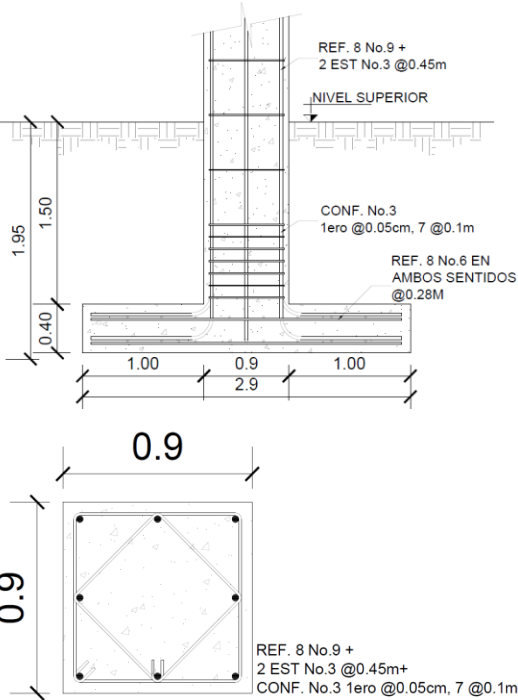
Detalles Estructurales FUENTE: Propia
